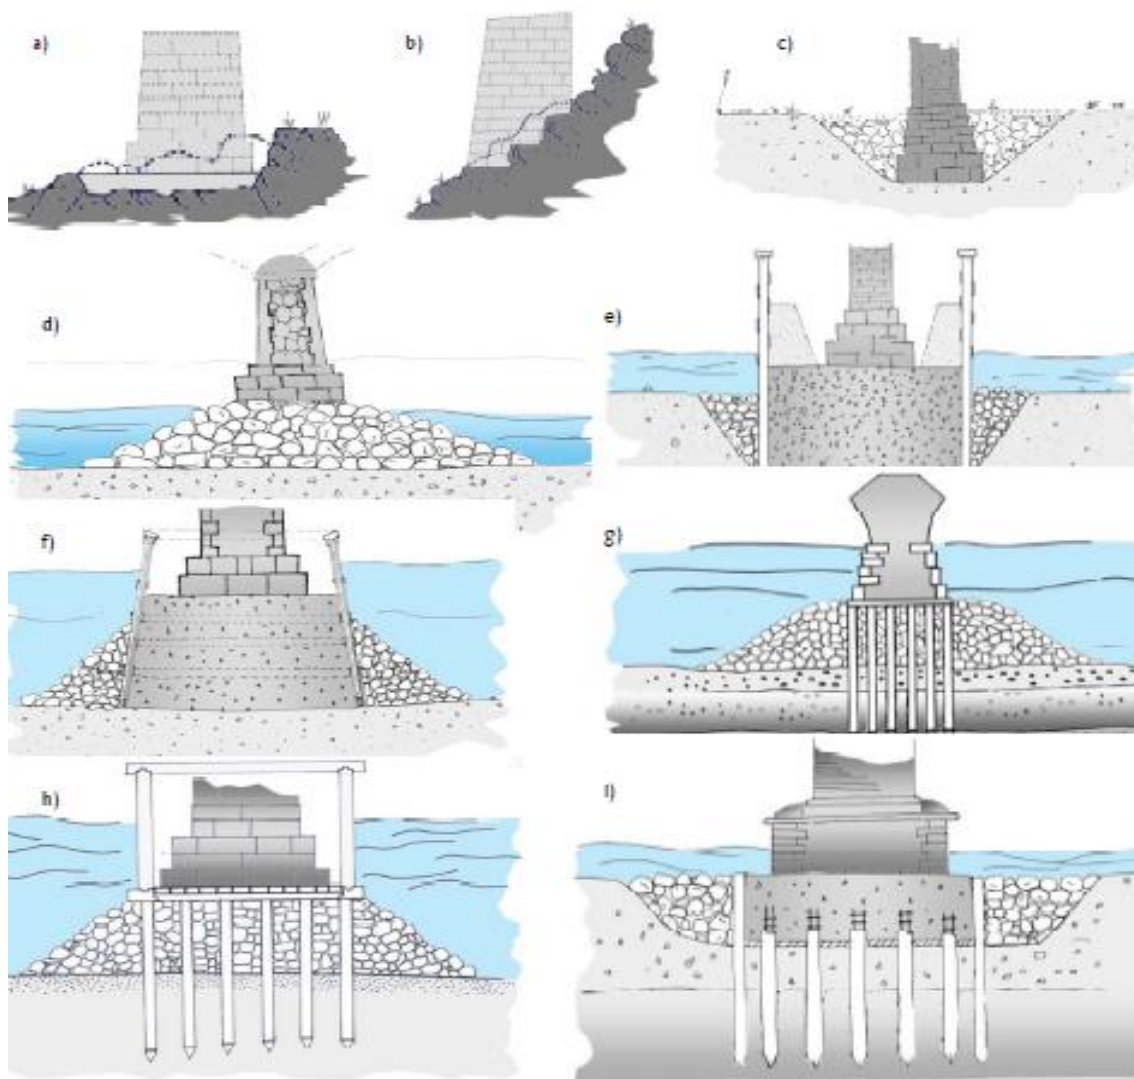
Tipos de Cimentación en puentes de mampostería. a) Cimentación directa en roca con excavación horizontal, b) cimentación directa en roca con excavación escalonada, c) cimentación directa sobre terrenos flojos, d) cimentación directa sobre escollera, e) cimentación directa con concreto sumergido y recinto de pilotes de madera, f) cimentación directa con concreto sumergido y cajones sin fondo, g, h) cimentación profunda con pilotes de madera, i) cimentación profunda con pilotes de concreto armado.
